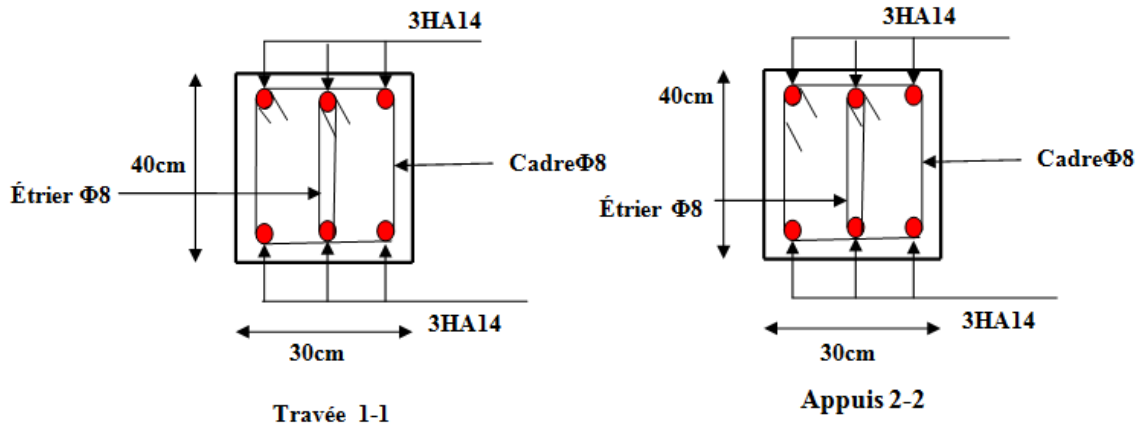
schéma de ferrailage de la poutre secondaire du RDC
